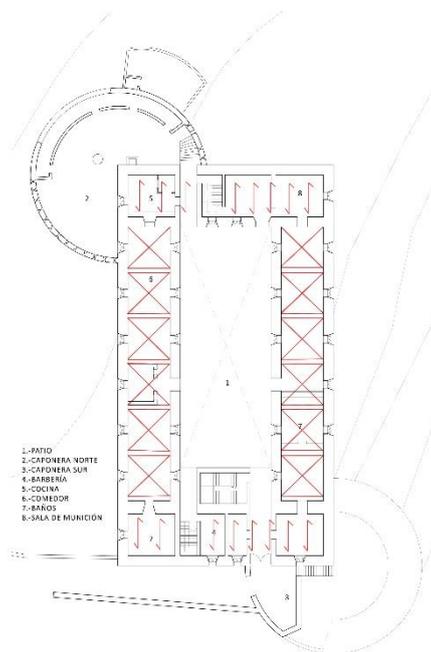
Plano de planta baja marcando el forjado de planta primera. (Las aspas marcan las bóvedas de arista y las flechas la dirección de las viguetas). Fuente: realizado por el autor de este TFG.
